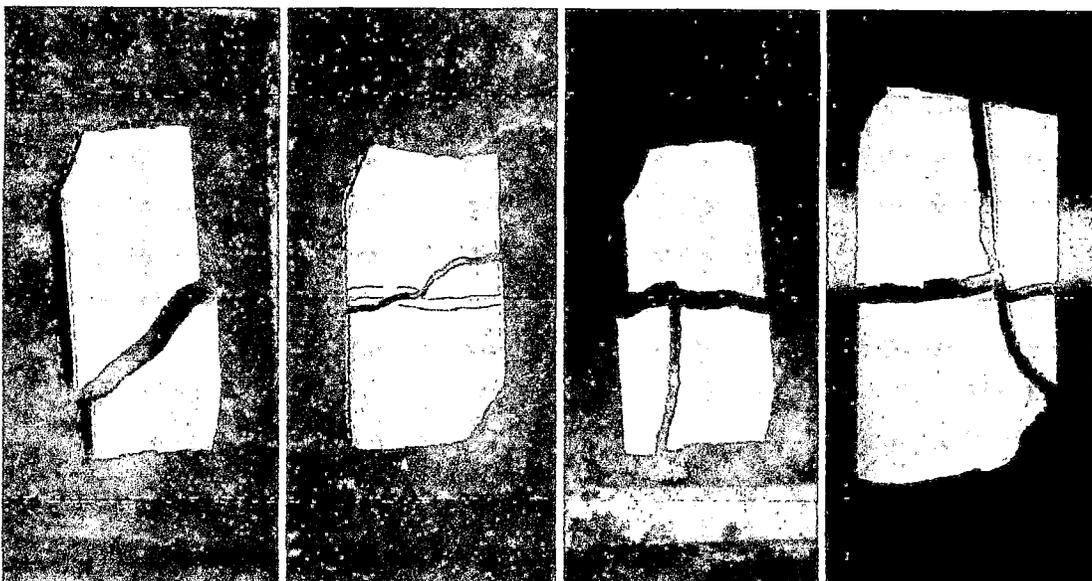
Falla diagonal y mixta respectivamente en teja ondulada
